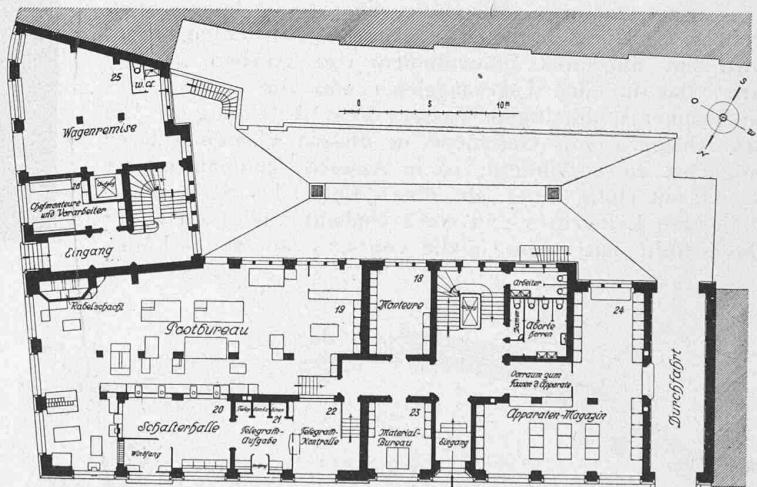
Grundriss vom Erdgeschoss — 1 : 500
